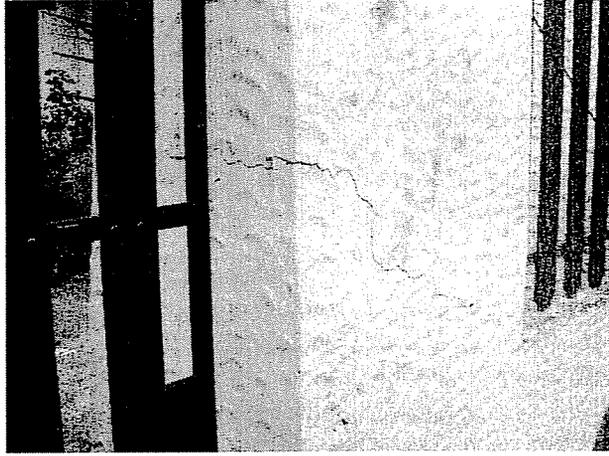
Grietas de dilatación entre muros, y entre muros y losa de entrepiso en el costado noroccidental del bloque U, primer nivel.
